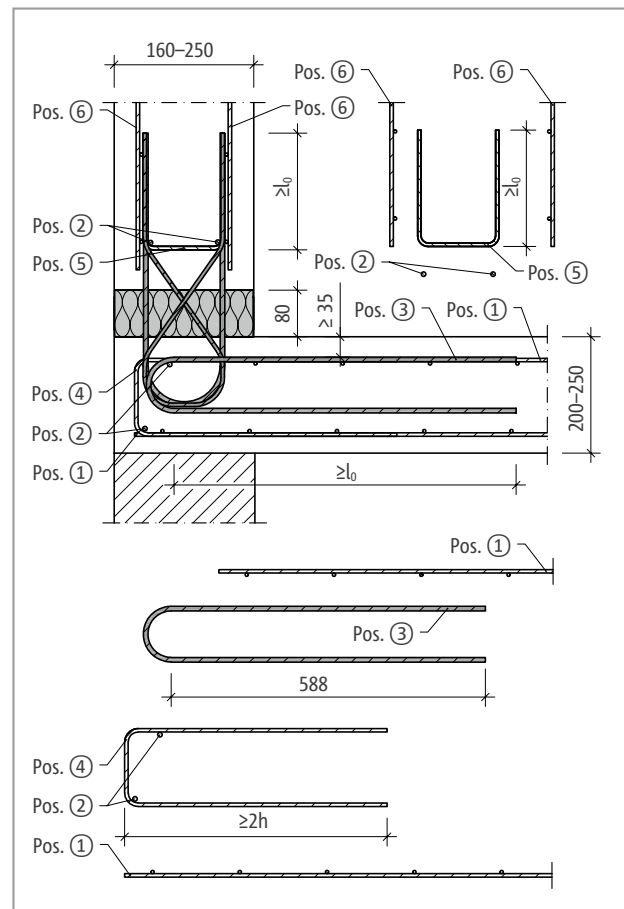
Schöck Isokorb® T tipo A: Armadura in situ exterior
